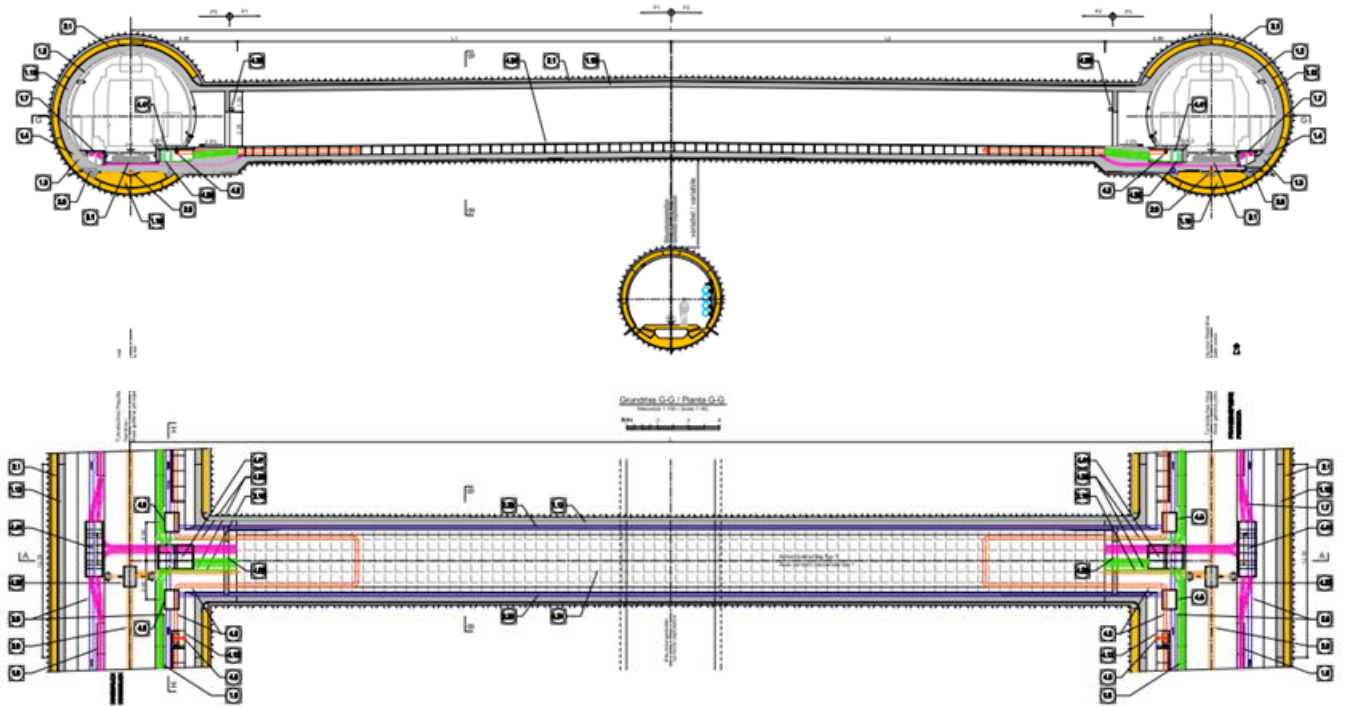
Querstollen Typ 1, ohne Abfluss zum Erkundungsstollen. Grundriss und Längsquerschnitt [121]
